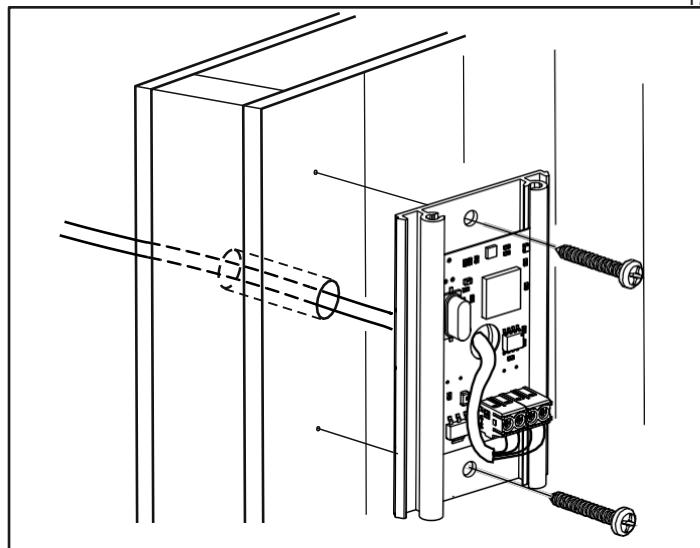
Installazione del sensore, cablaggio attraverso la parete
